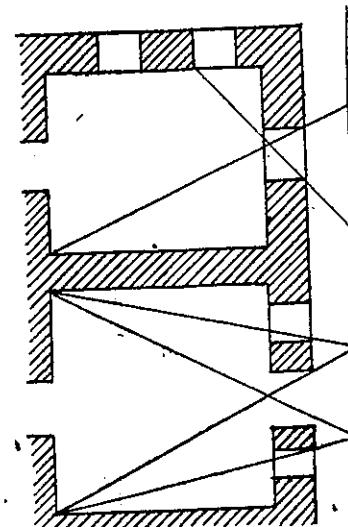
Привязка к причалке планов двух смежных, не связанных между собою помещений с проемами, выходящими на один фасад
